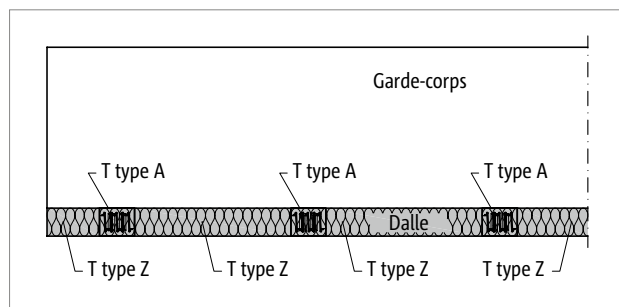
Schöck Isokorb® T type A disposition horizontale : vue avec garde-corps posé en avant
